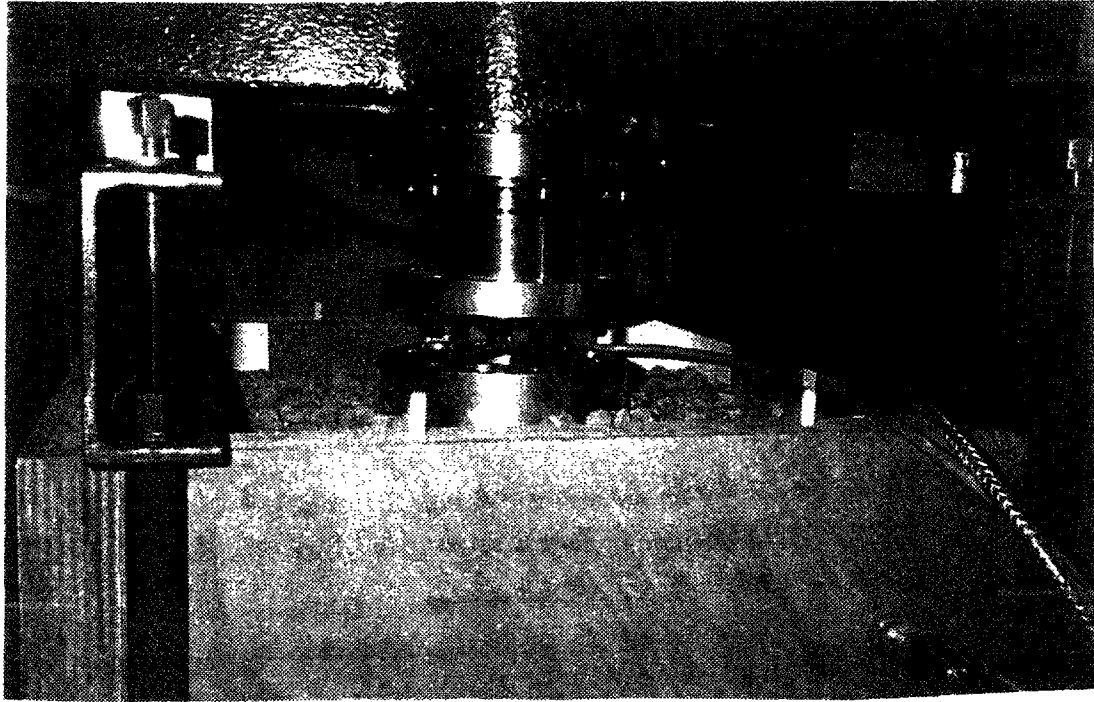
coupe du blochet et de son dispositif de fixation.
